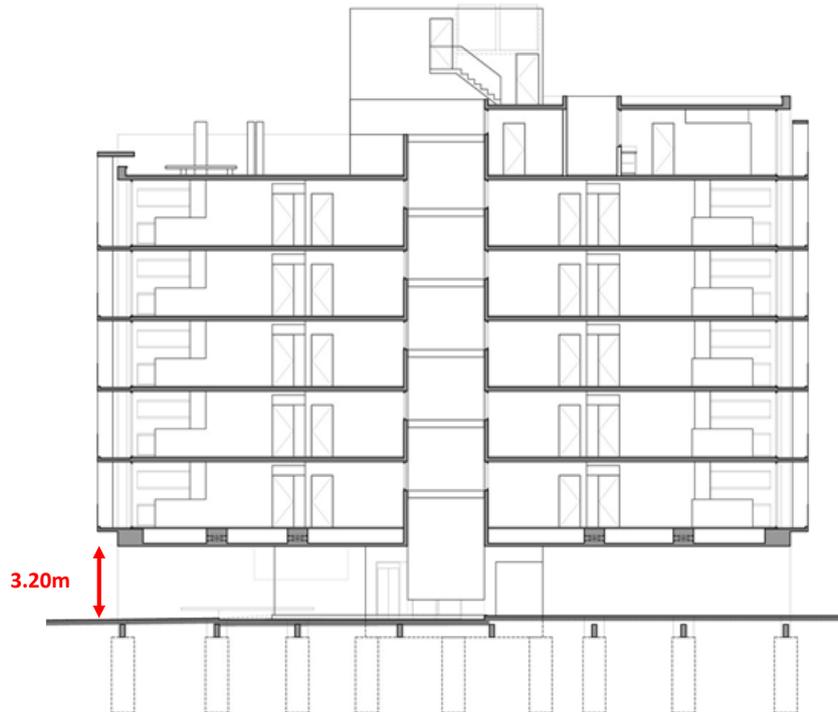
Corte longitudinal. Fuente: Imagen obtenida de la WEB
